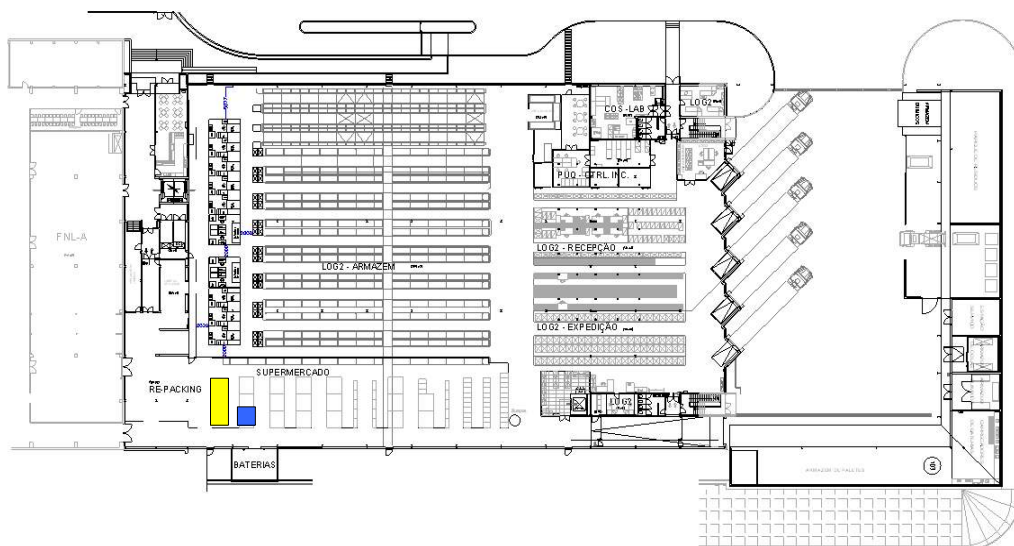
Layout proposto para a construção de paletes com KLT para fornecedor
